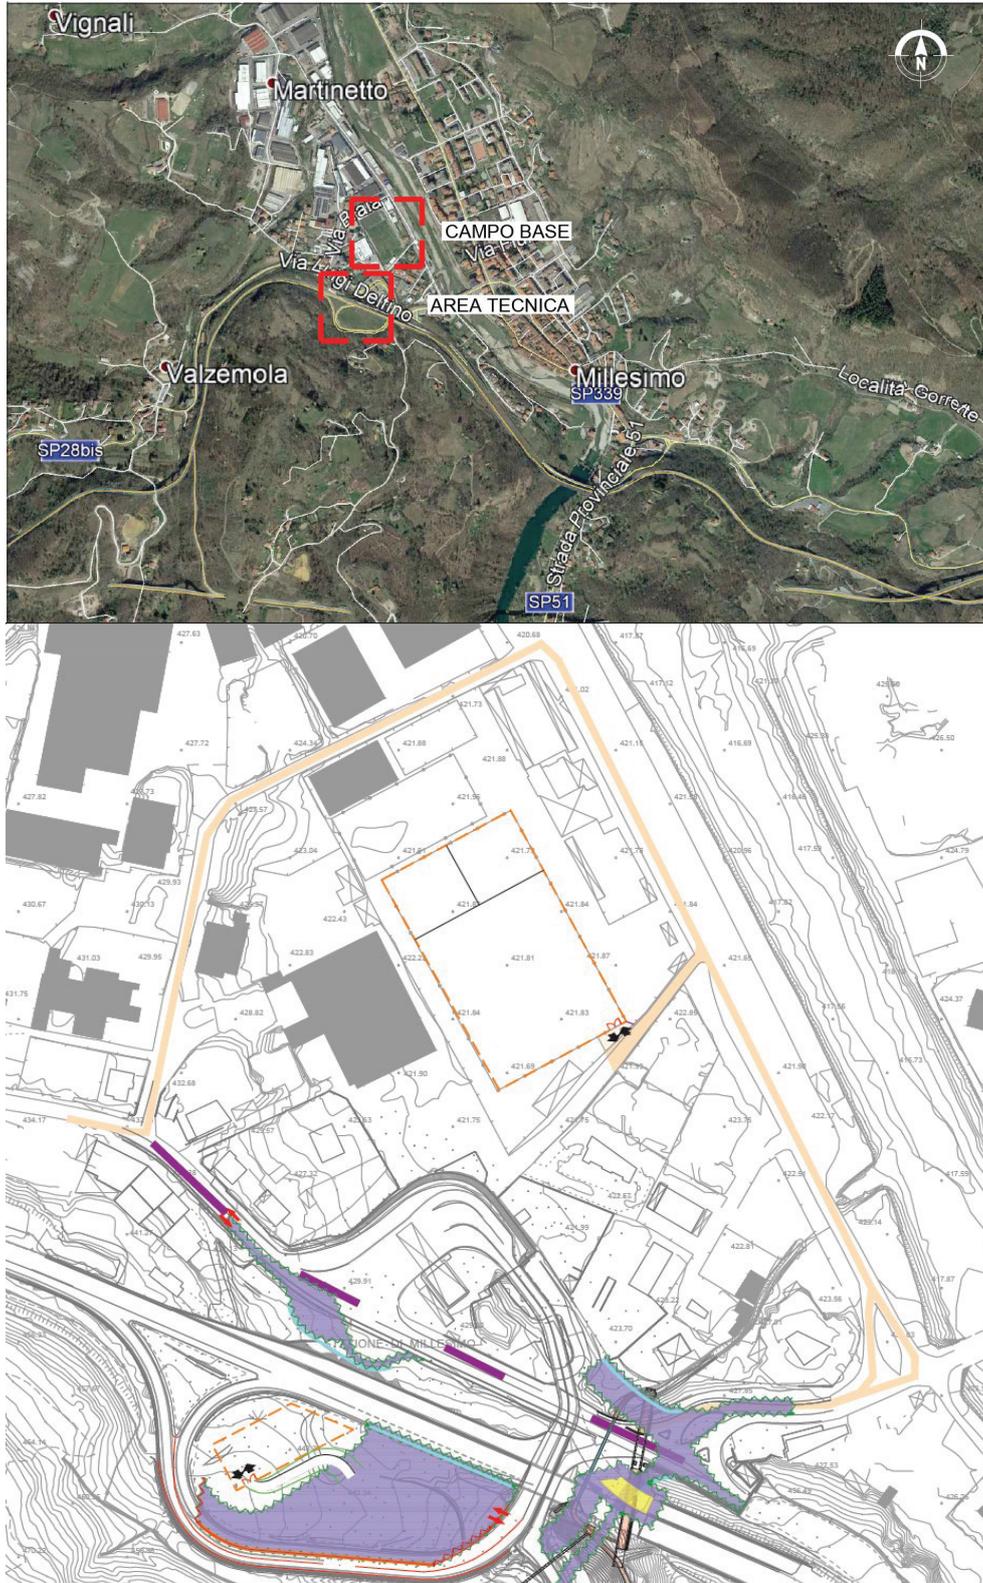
Localizzazione e planimetria generale della cantierizzazione
